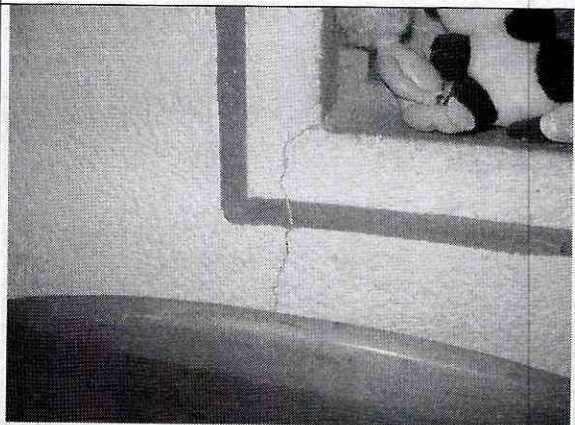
Fisura en muros del primer piso sector posterior
